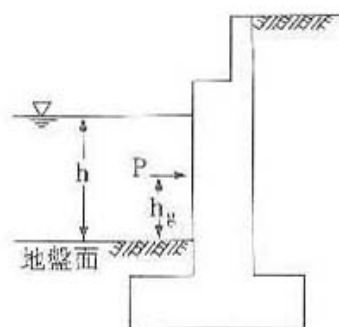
壁状構造物に作用する地震時動水圧
